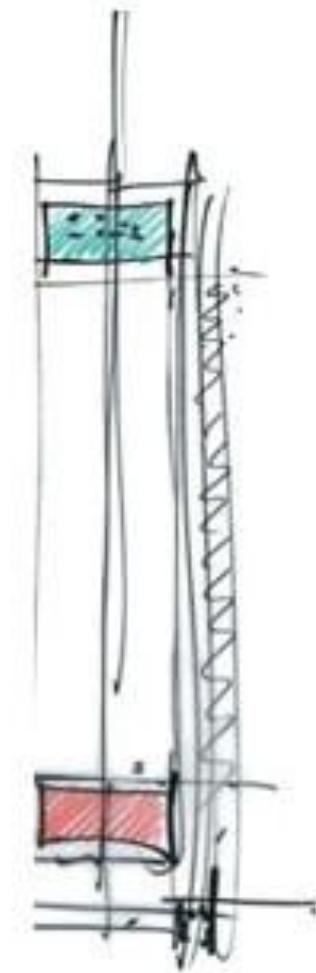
Schizzo dell'architetto Renzo (Piano (Fonte: RPBW))
